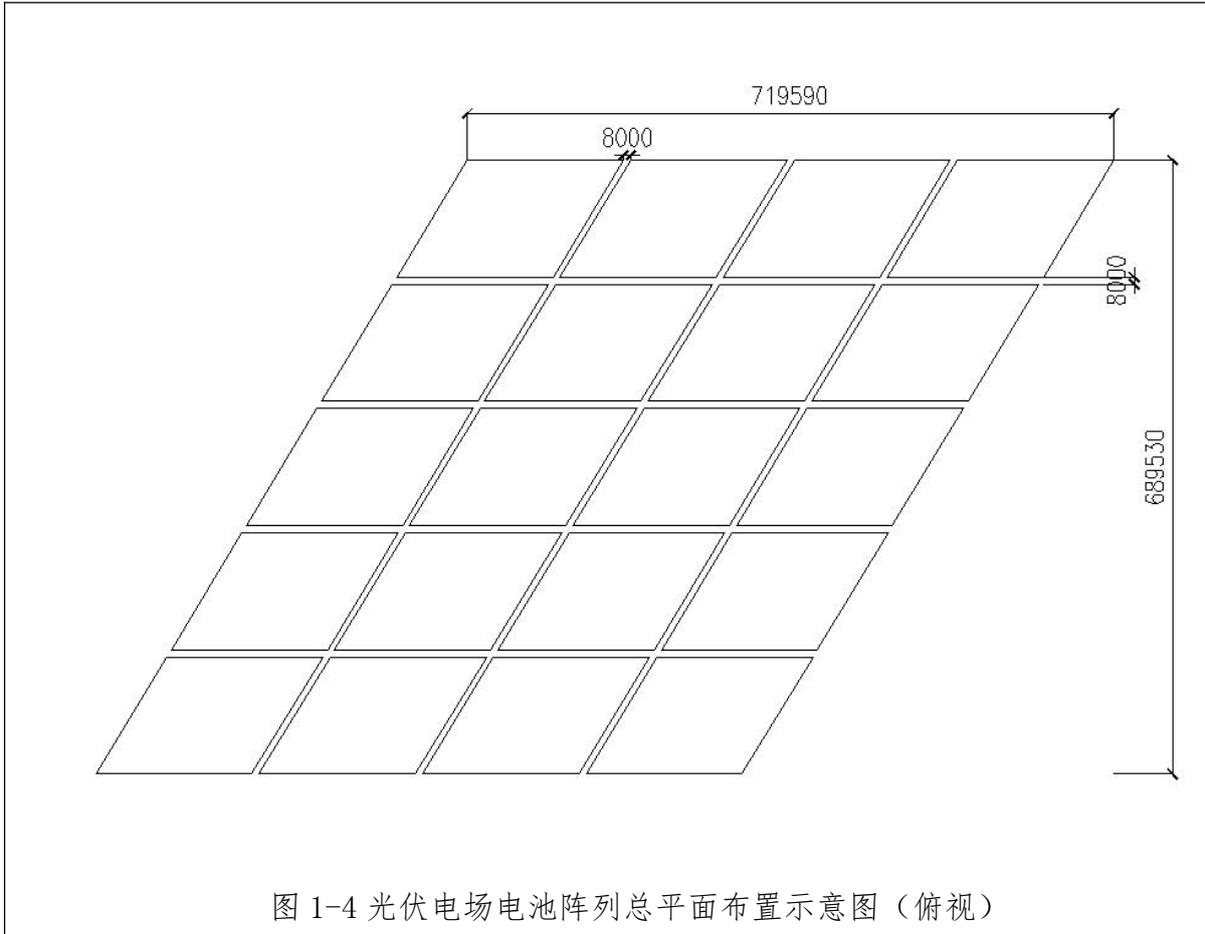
光伏电场电池阵列总平面布置示意图（俯视）
